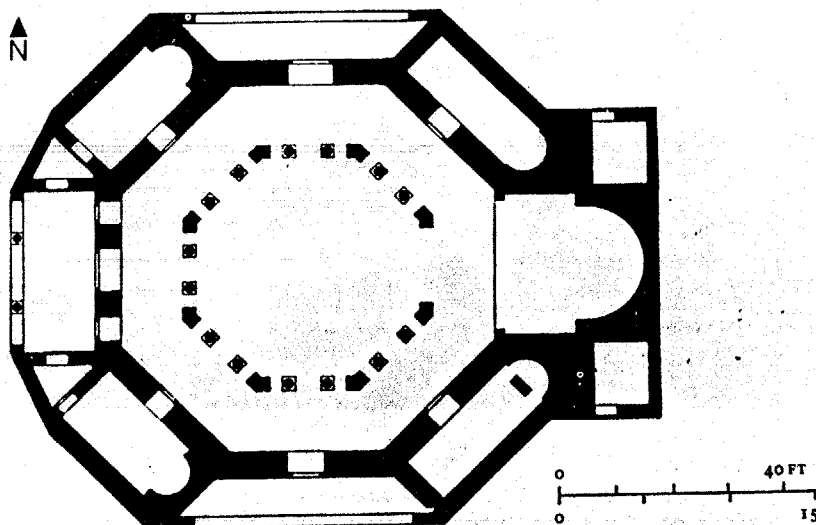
： ガリチン山のテオトコス教会堂1階平面図 (after Krautheimer)
